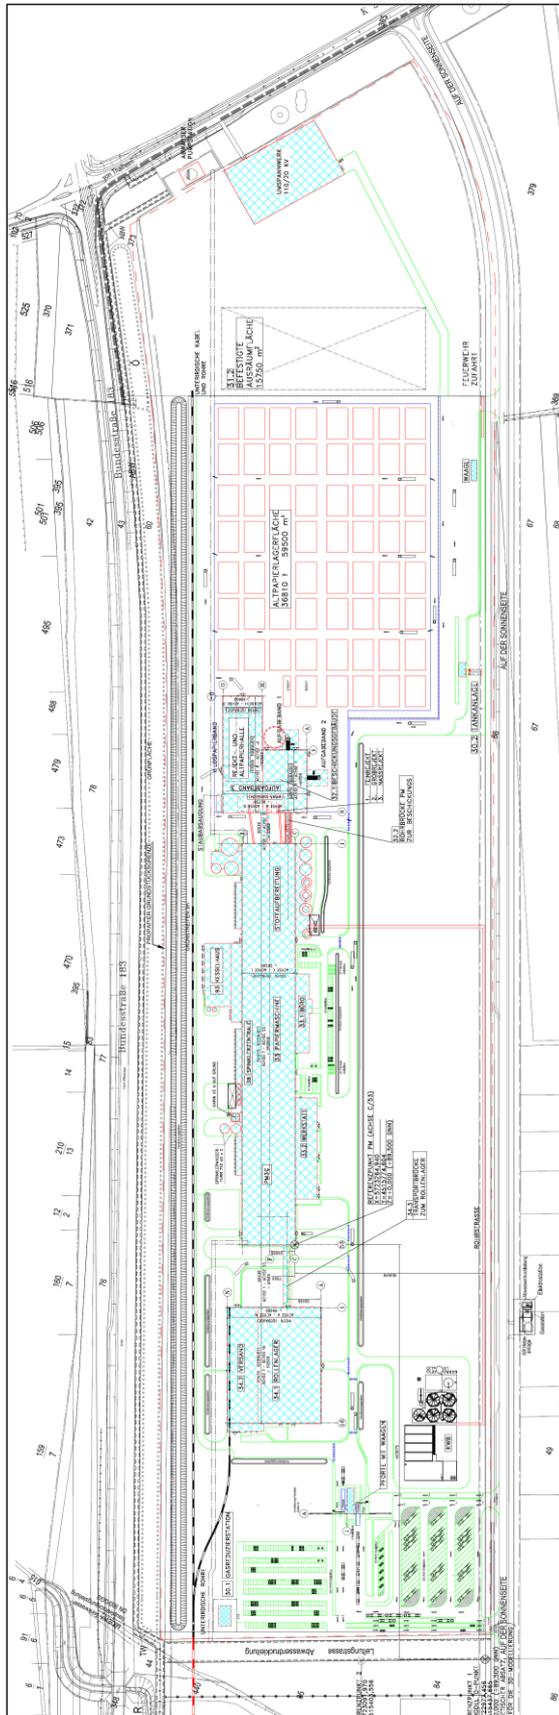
Layout der geplanten Papierfabrik PM3 (Detaildarstellung im Antrag enthalten)
